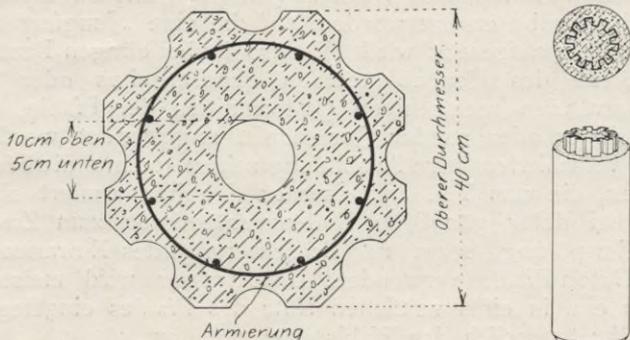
Pfahl der «Corrugated Concrete Pile Co.».
